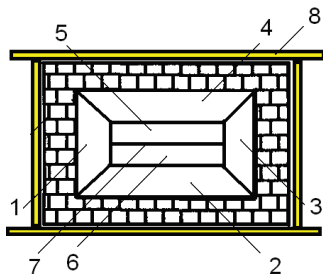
Схема предохранительной разрушающейся конструкции ограждения зданий.
